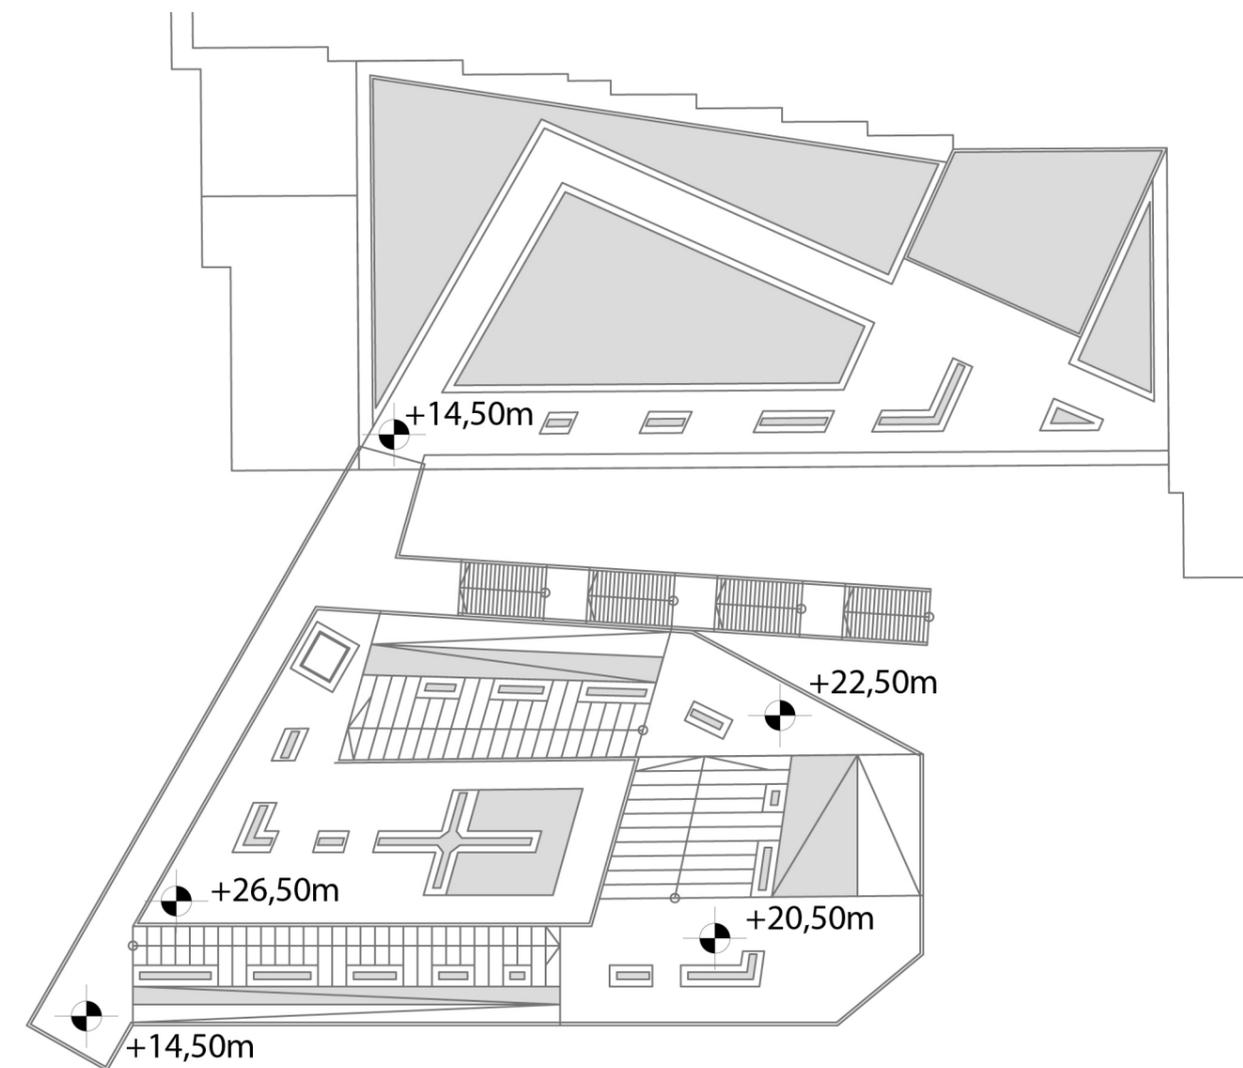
Grundriss Parkterrasse Marriotthotel und neues Konzerthaus, Dachgeschoss, M: 1:500
